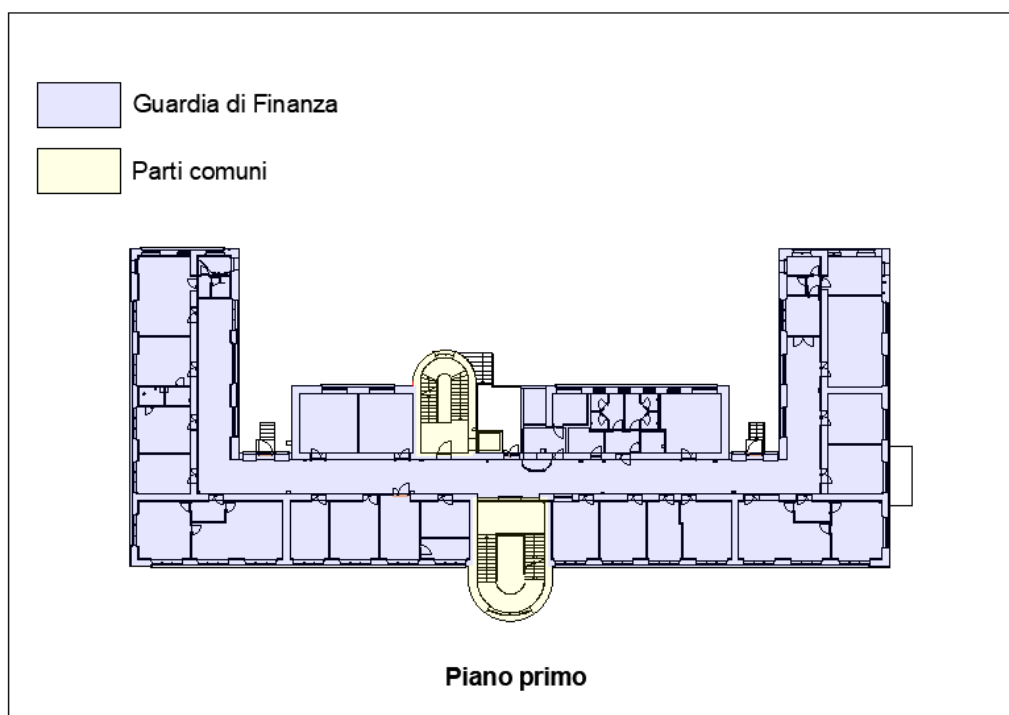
Pianta piano primo: attuale Amministrazione utilizzatrice
